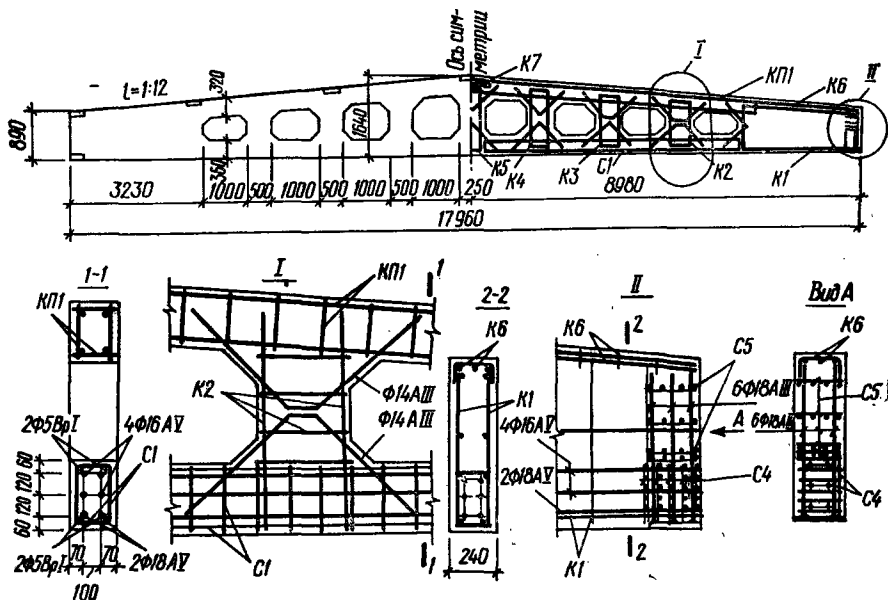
Двускатная решетчатая балка покрытия пролетом 18 м
